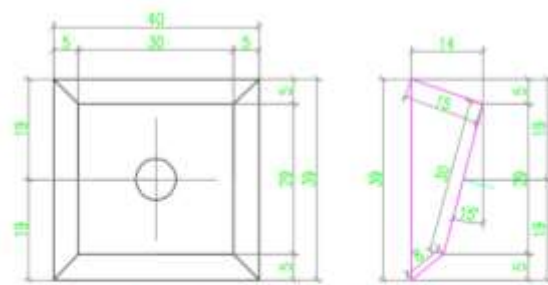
Plano sección transversal muro anclado 2, fuente propia.
